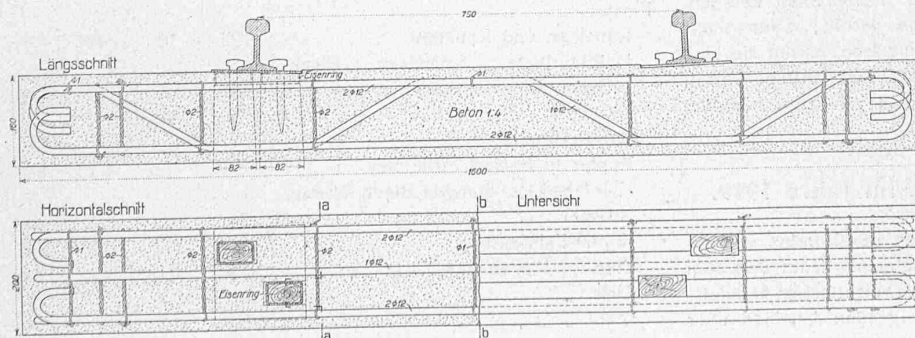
und 2. Schnitte und Draufsicht der Eisenbeton-Schwelle. — Masstab 1:12.
